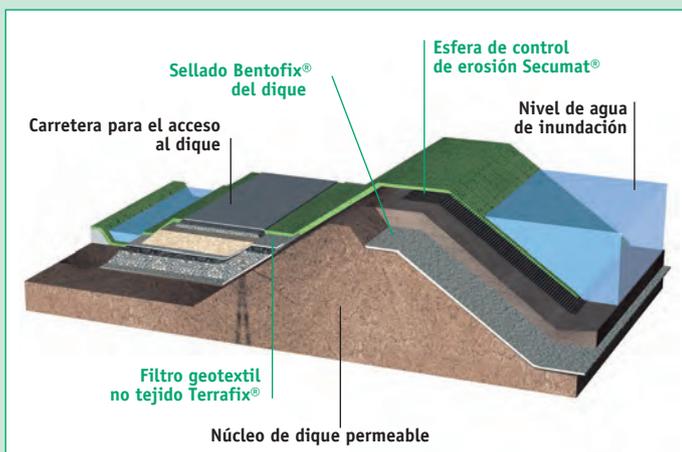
Sección transversal de un dique sellado con revestimiento de geosintético de arcilla Bentofix® y filtro de carga corriente abajo con geotextil Terrafix® no tejido.
